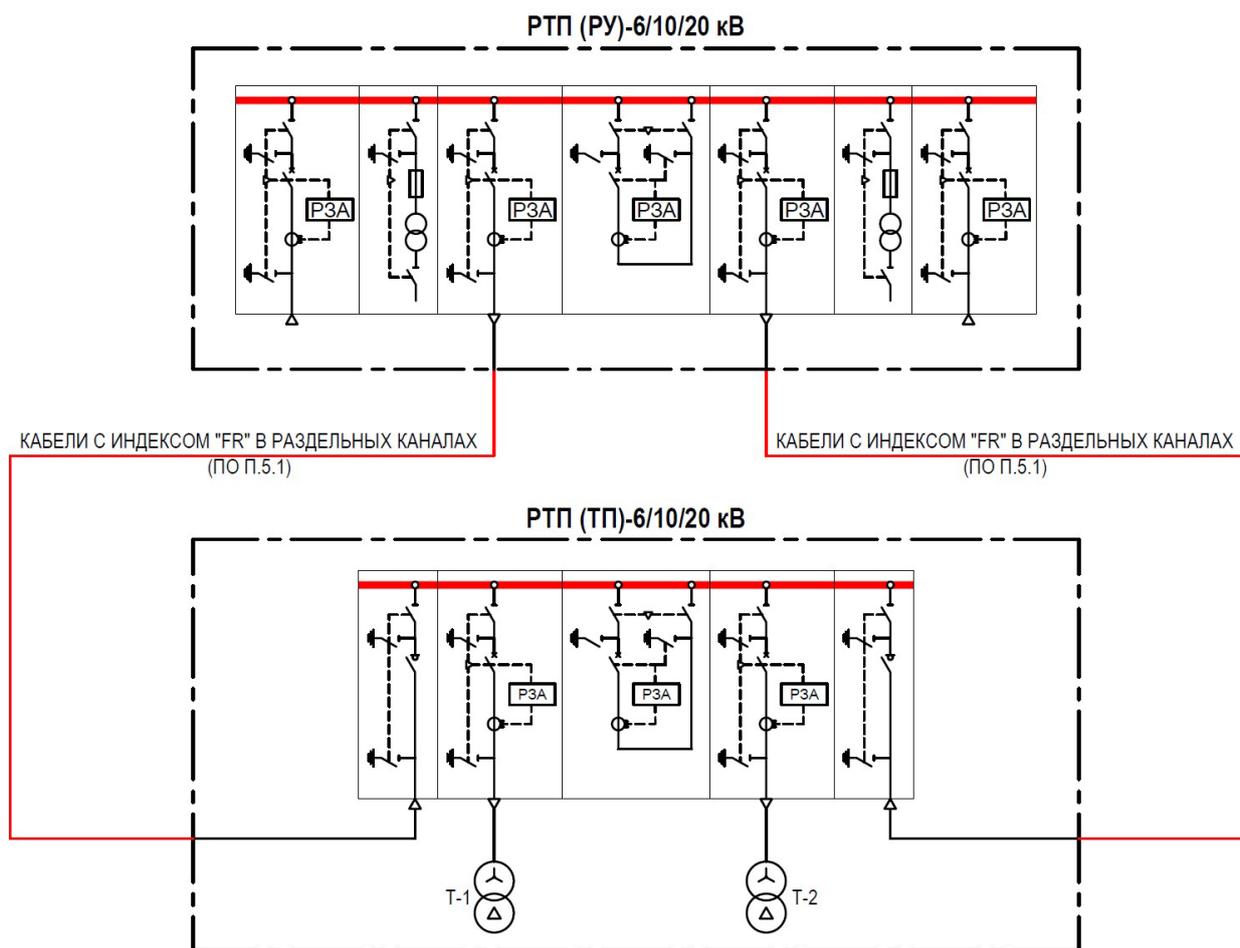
Вариант организации электроснабжения при размещении ТП на технических этажах высотных зданий или ТП не являются встроенными, по периметру (границе) здания, и не имеющих непосредственного выхода наружу
